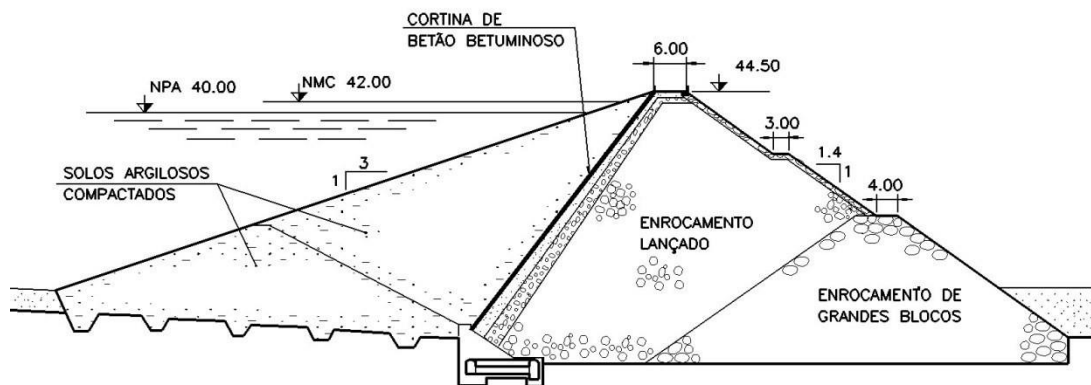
Perfil tipo da barragem de Vale do Gaio (Pimenta, 2008)
